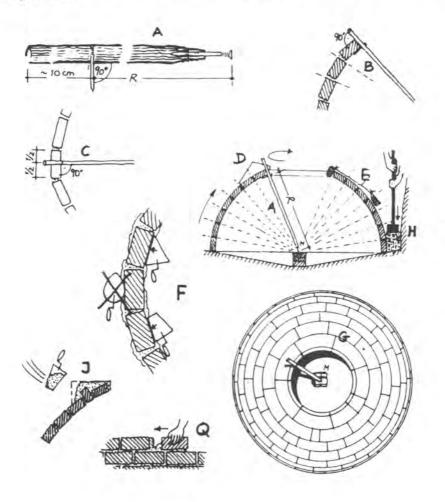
Construcción de un digestor a baja presión modelo Sasse, en tierra laterita (ref.36)
